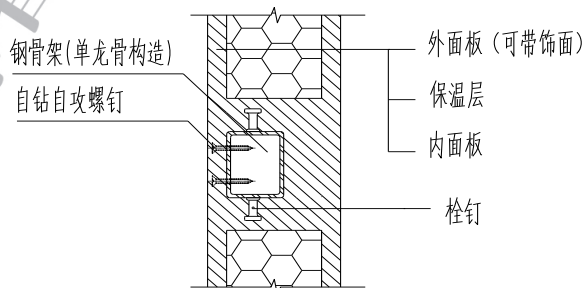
单龙骨整体预制复合墙板基本构造示意图
